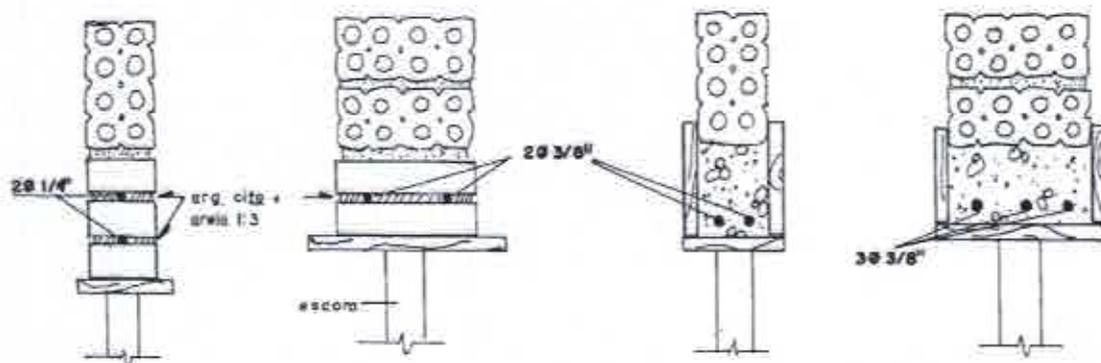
Vergas em alvenaria de tijolo furado para vãos até 1,00m e entre 1,00m e 2,00m.
